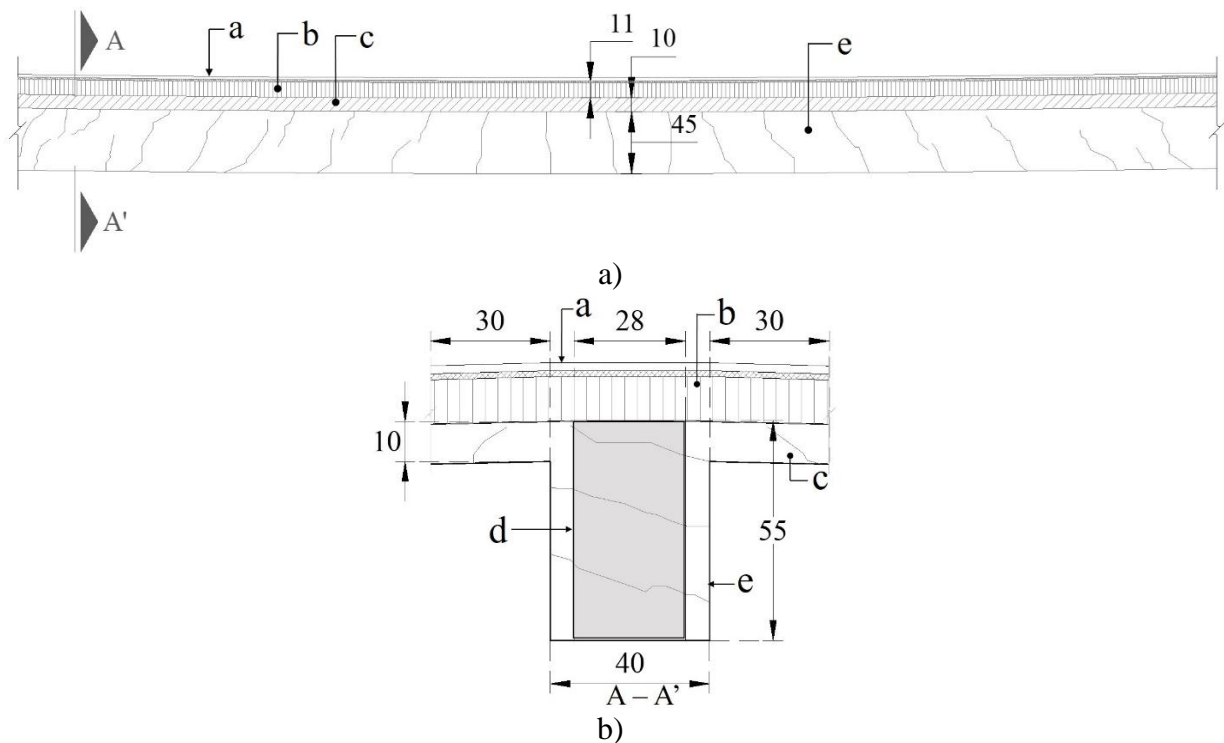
EA de vigas de concreto armado; a) vista longitudinal; b) vista transversal. Onde: a= acabamento de piso, b= preenchimento de concreto simples, c=laje de concreto armado, d=seção transformada de viga de concreto considerada para o cálculo do momento de inércia fissurado, e=viga fissurada de concreto armado, cotas em cm.
